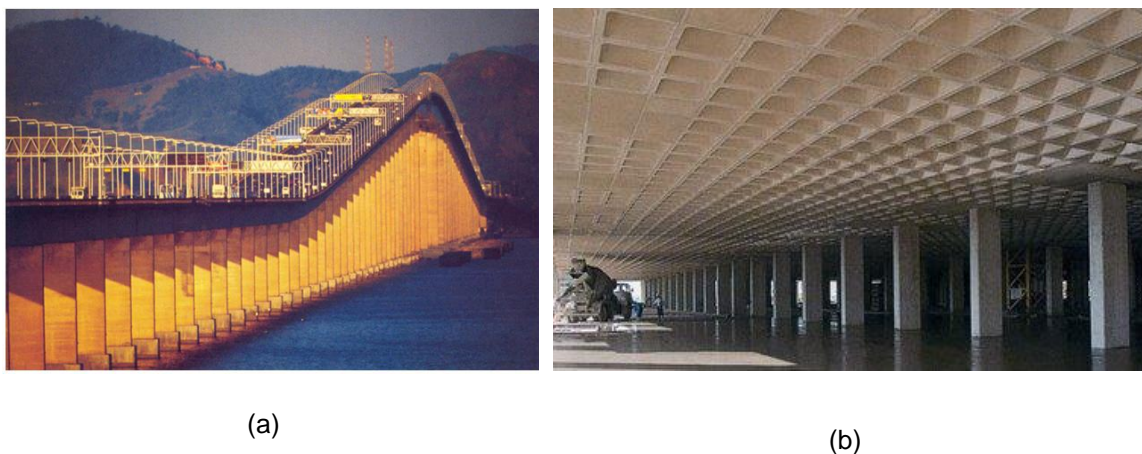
Aplicações de vigas de concreto armado com seção T: (a) ponte Rio-Niterói (fonte: <http://www.ponte.com.br/concessionaria/sobrea>); (b) laje nervurada típica de edificações modernas.
